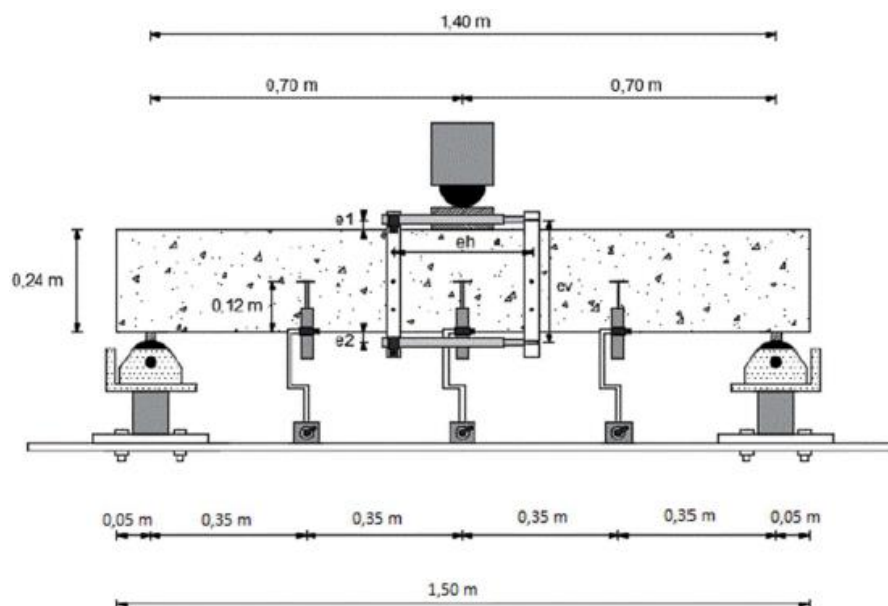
Esquema detalhado do equipamento de ensaio (Silva, 2015)
